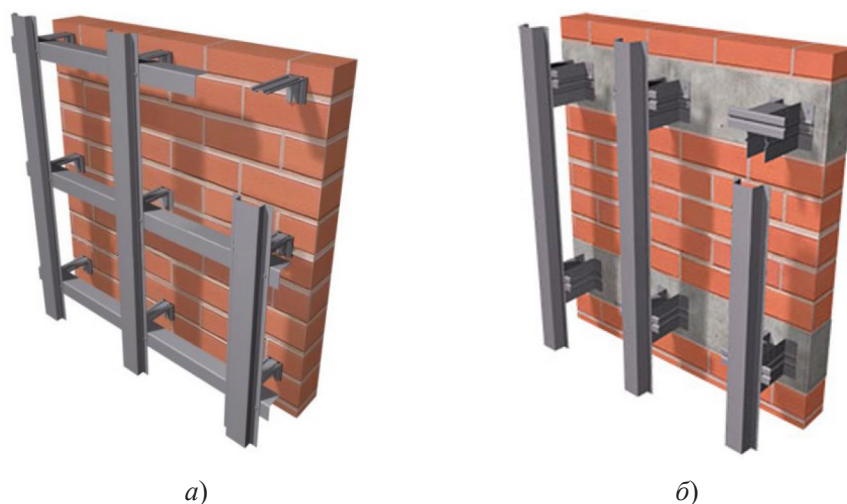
Способы крепления подсистемы навесных вентилируемых фасадов каркасных зданий:
